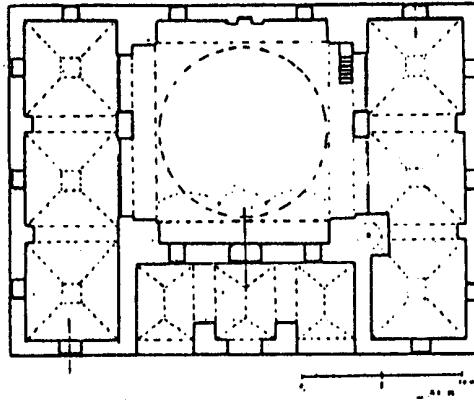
مسقط أفقي للمدرسة المرجانية ببغداد - الطابق الارضي (الايمن)
